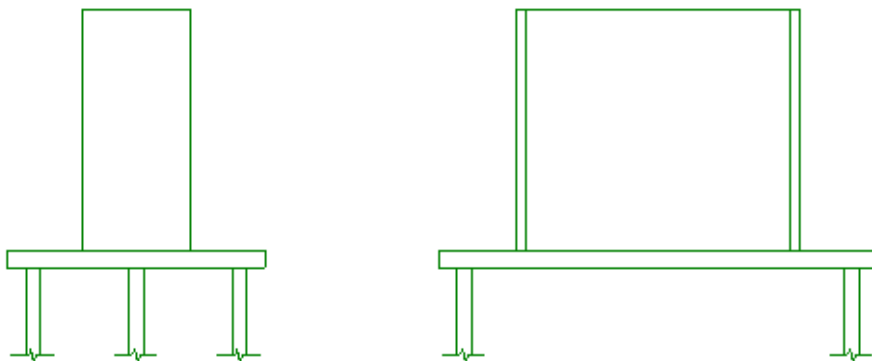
Alzado y perfil de la placa de anclaje.
